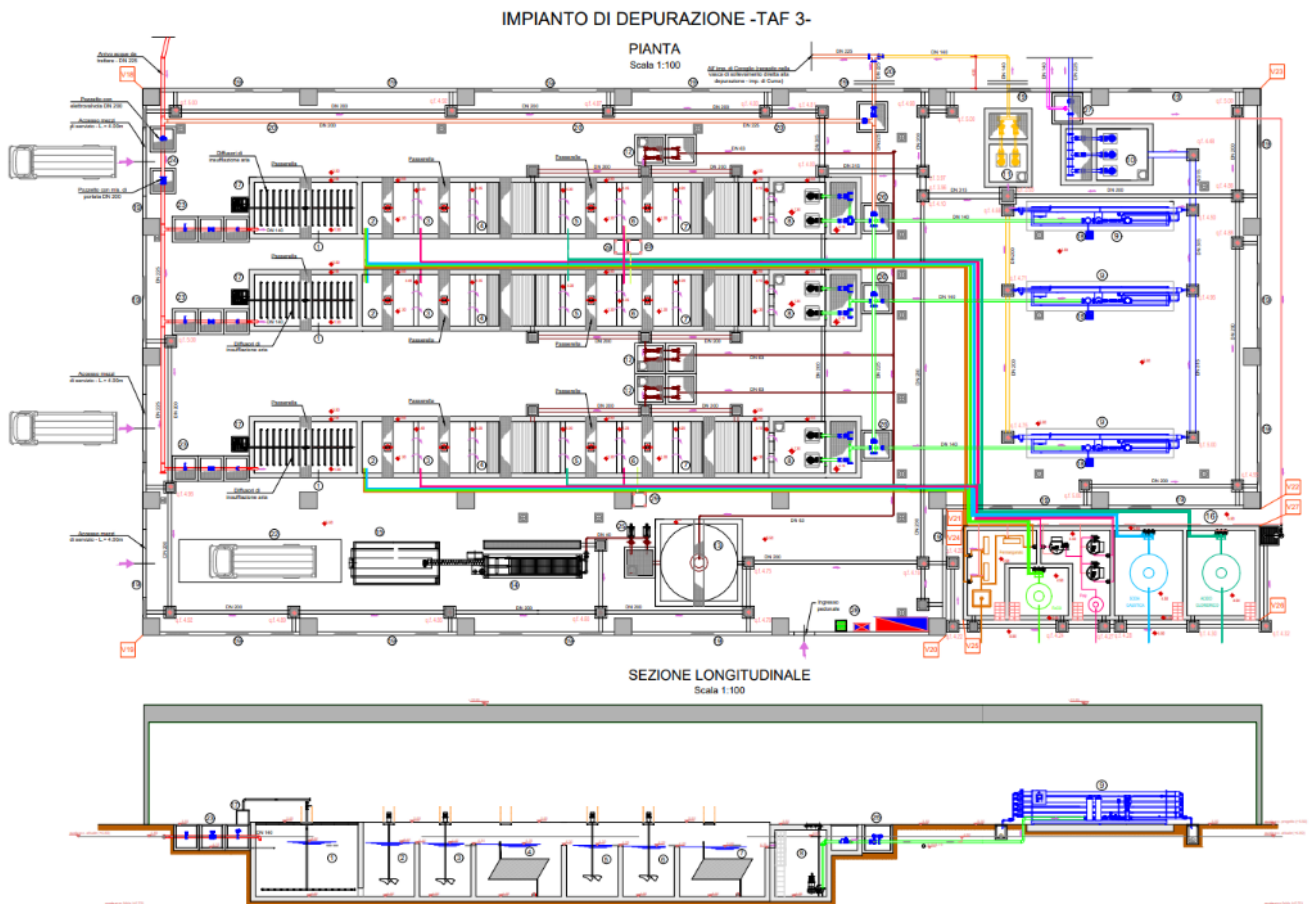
Impianto di Depurazione TAF 3 Pianta e sezione
